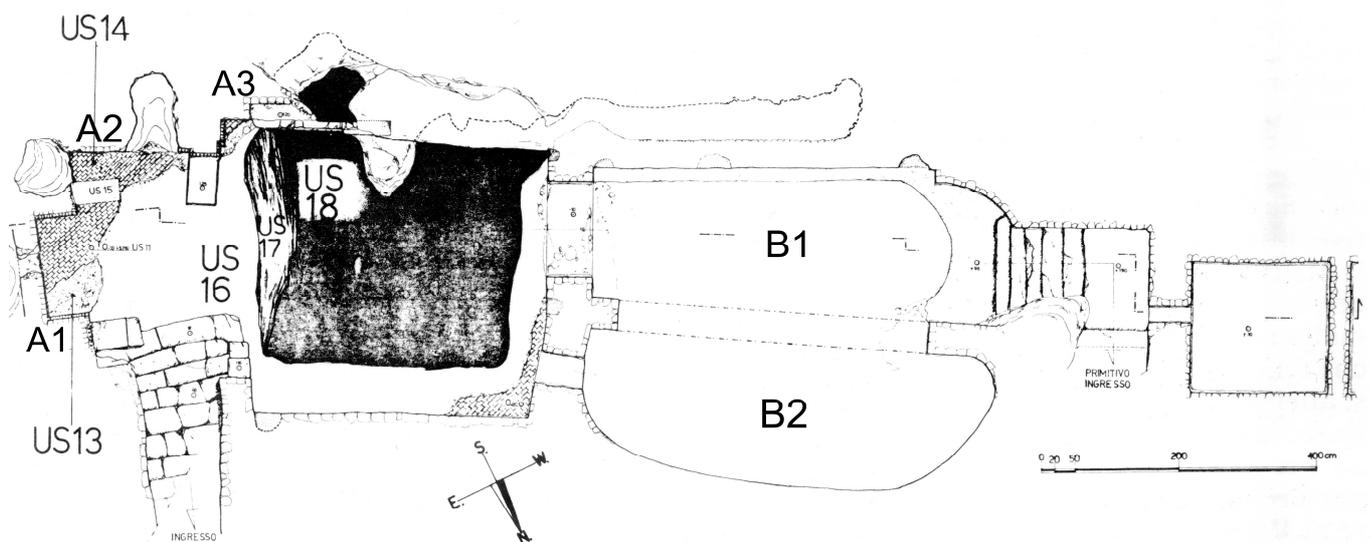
Planimetria degli ambienti ipogei (fonte: Fiore Cavaliere - Carretta 1988, modificato dall'autore).
